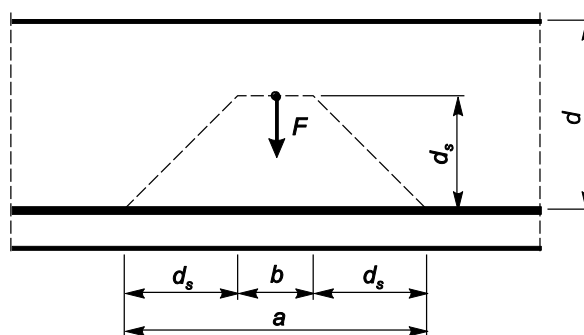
Схема для расчета железобетонных элементов на отрыв
